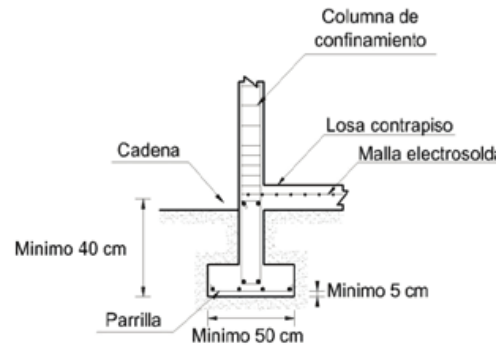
Requisitos para zapatas aisladas. Elaborado: Autores.
